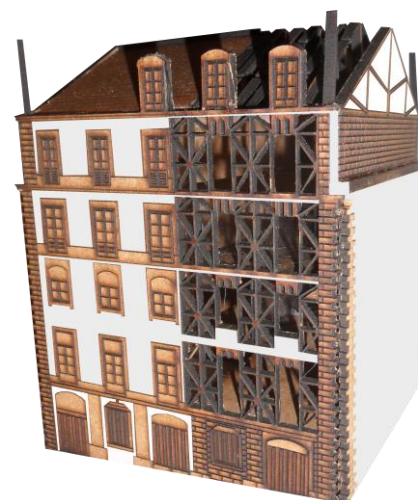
Maqueta tridimensional, expositiva (frente) do género construtivo (dir.) e fachada Reabilitada (esq.) retocada, criação do autor. Escala 1/100
